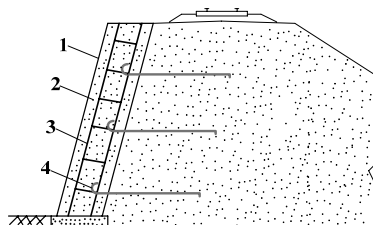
Анкерная подпорная стена из монолитной железобетонной облицовки
